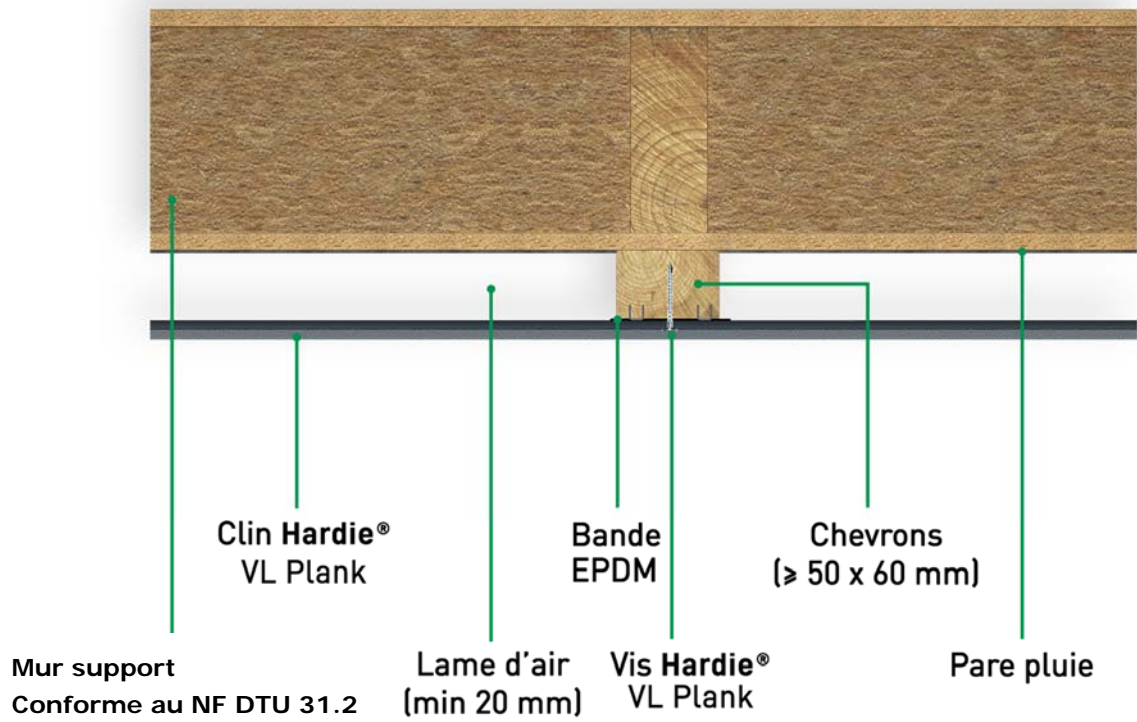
Coupe horizontale sur COB (pose verticale des clinis)
